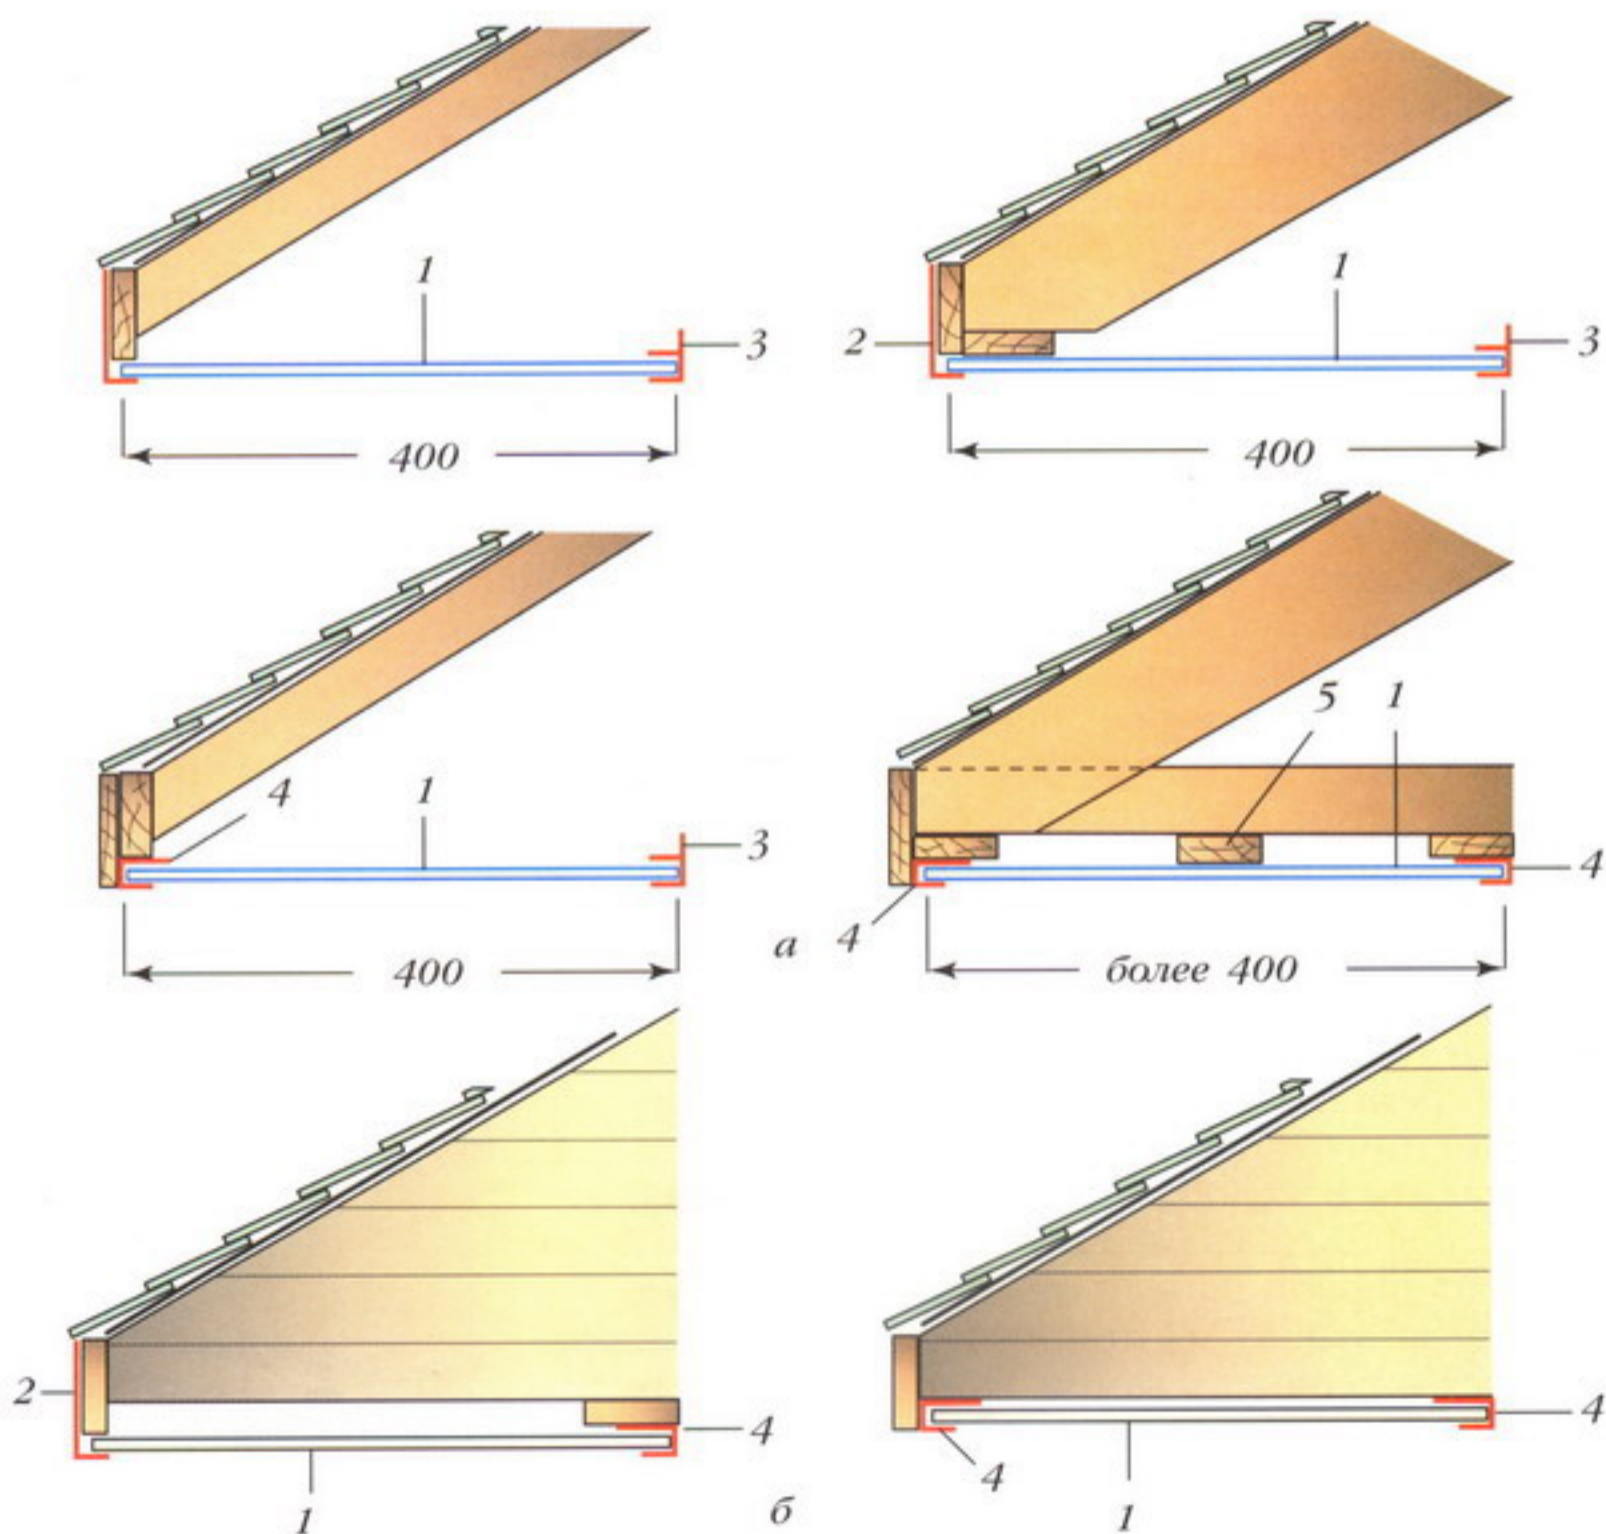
Варианты крепления софитов: а — на открытом свесе крыши; б — на закрытом свесе крыши; 1 — софит; 2 — фаска; 3 — F-профиль; 4 — J-профиль; 5 — дополнительный брусок
